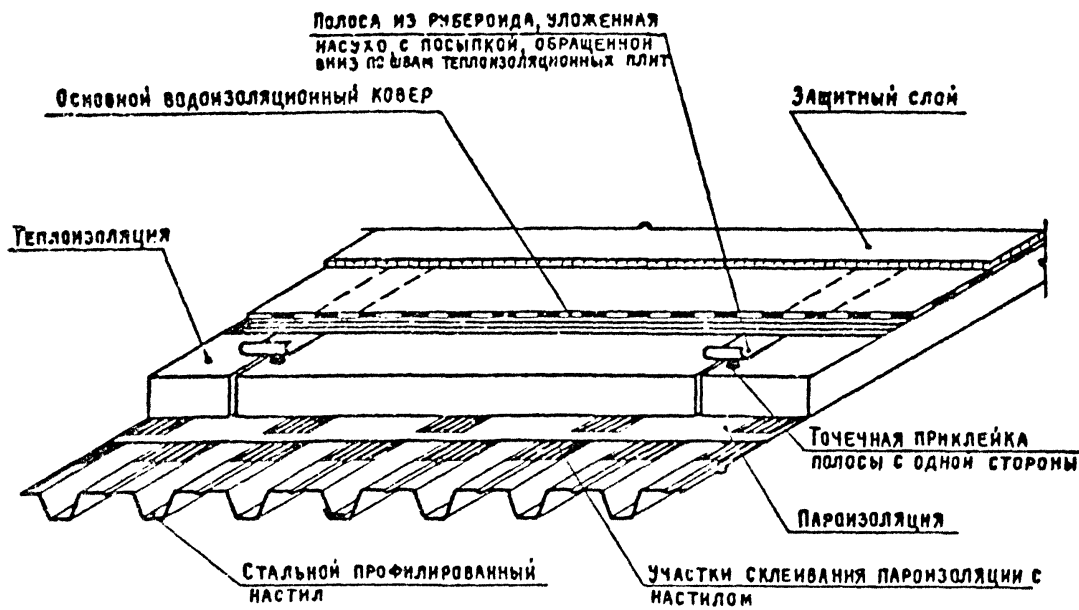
Для покрытий с теплоизоляцией — основанием под кровлю
